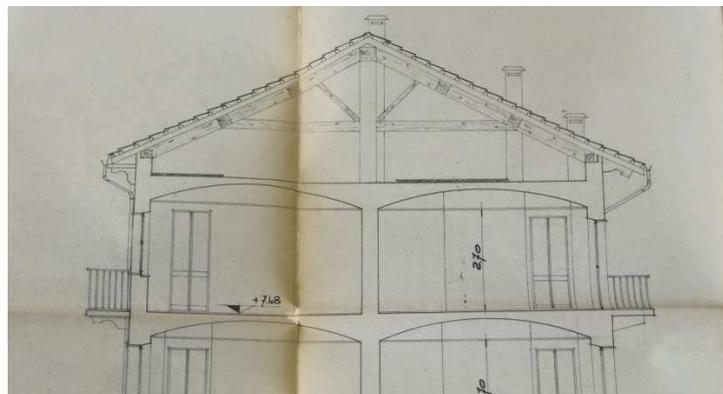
Estratto sezione edificio ottocentesco del centro storico, Settimo Torinese
